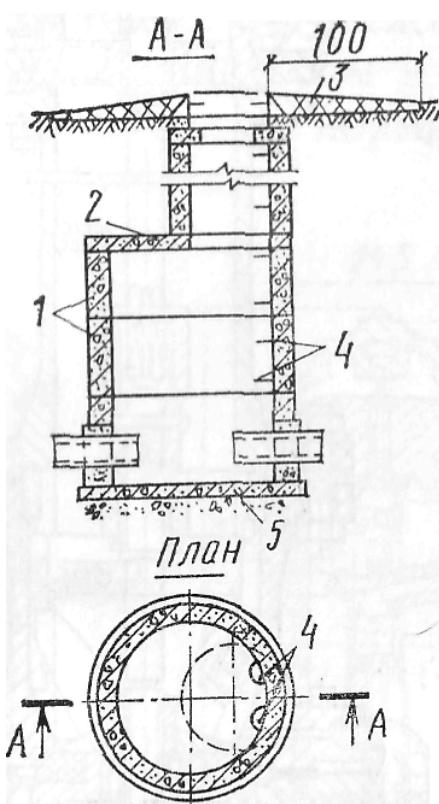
Сборный железобетонный смотровой колодец, выполняемый в сухих грунтах
